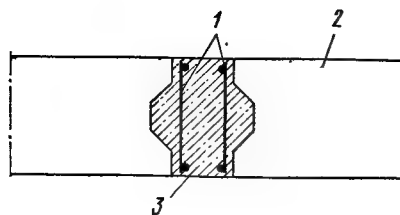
Узел усиления кладки стен из бетонных блоков
